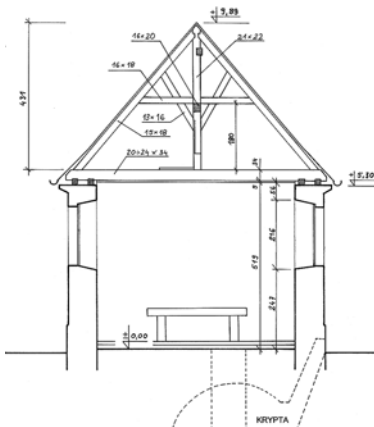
Konstrukcja storczykowa nad prezbiterium
